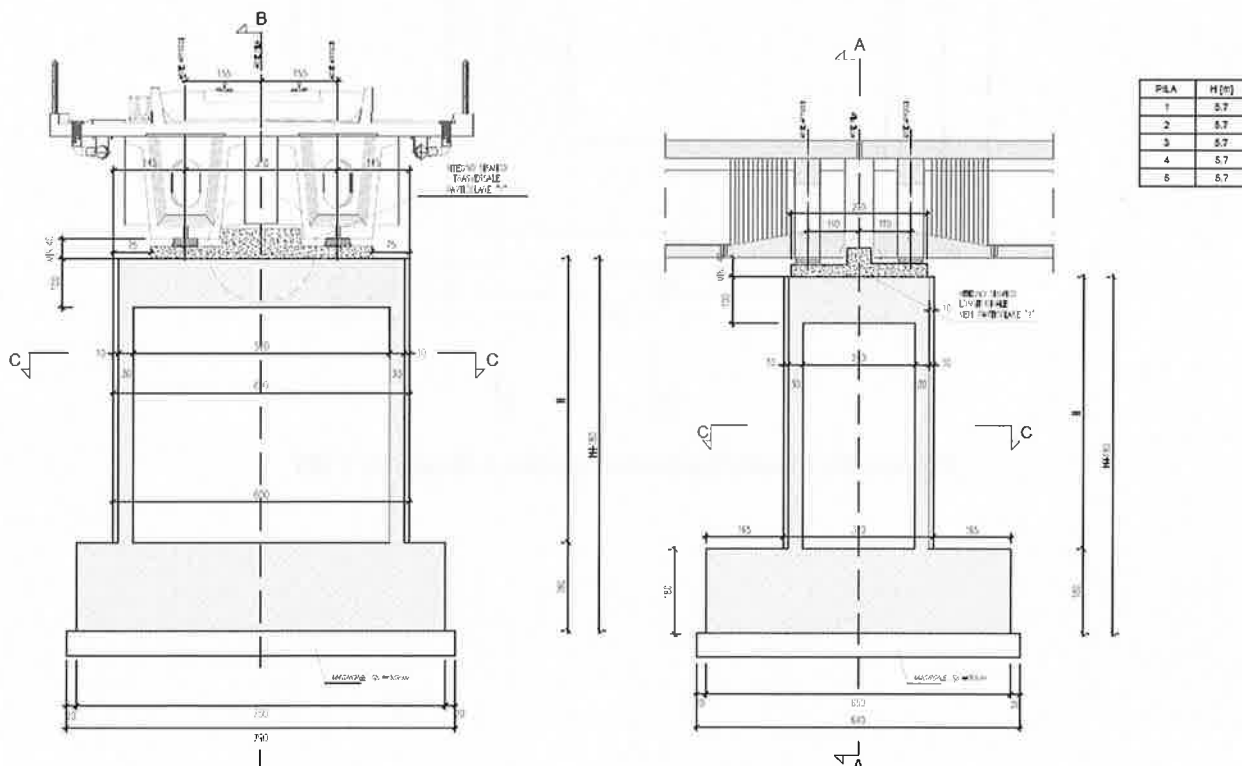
Sezione trasversale e longitudinale pile Bonorva VI03
